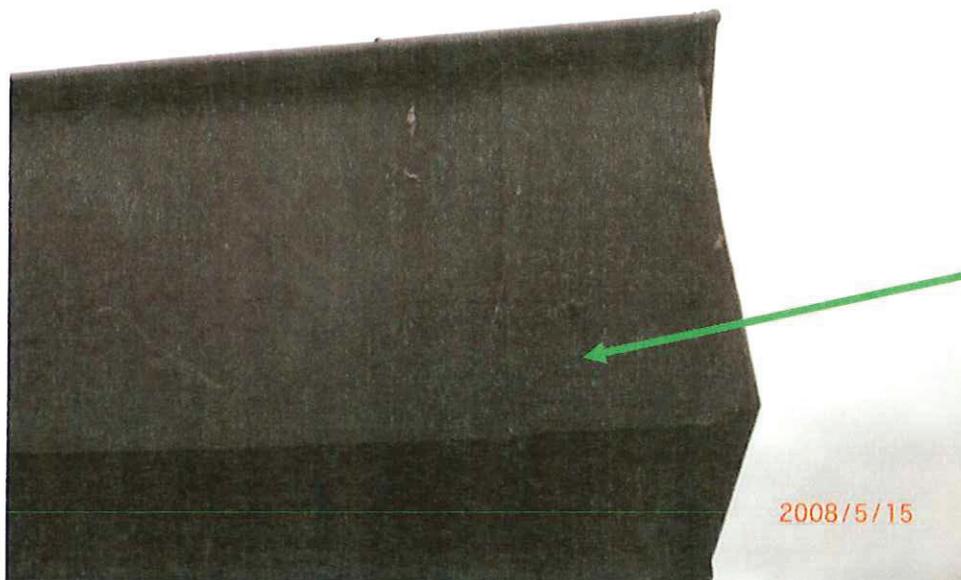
Bâtiment A – Toiture – Cabanon machinerie ascenseur – Bardage
